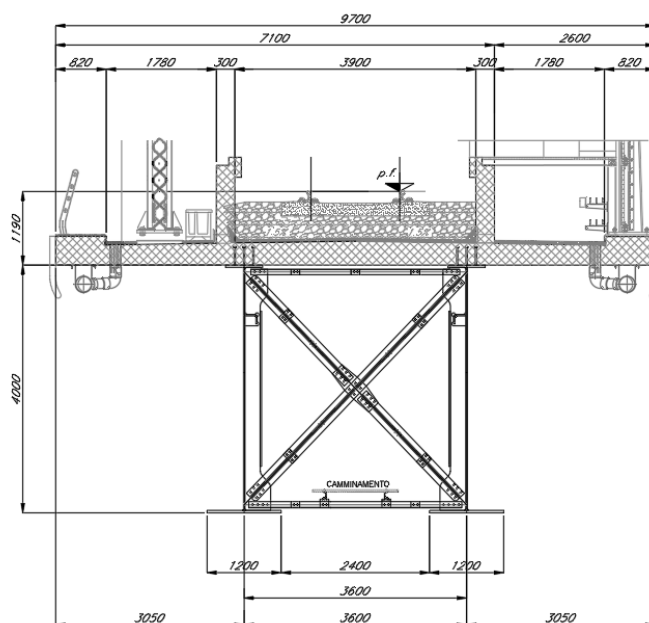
Sezione trasversale campate in acciaio-clc L=50 m
